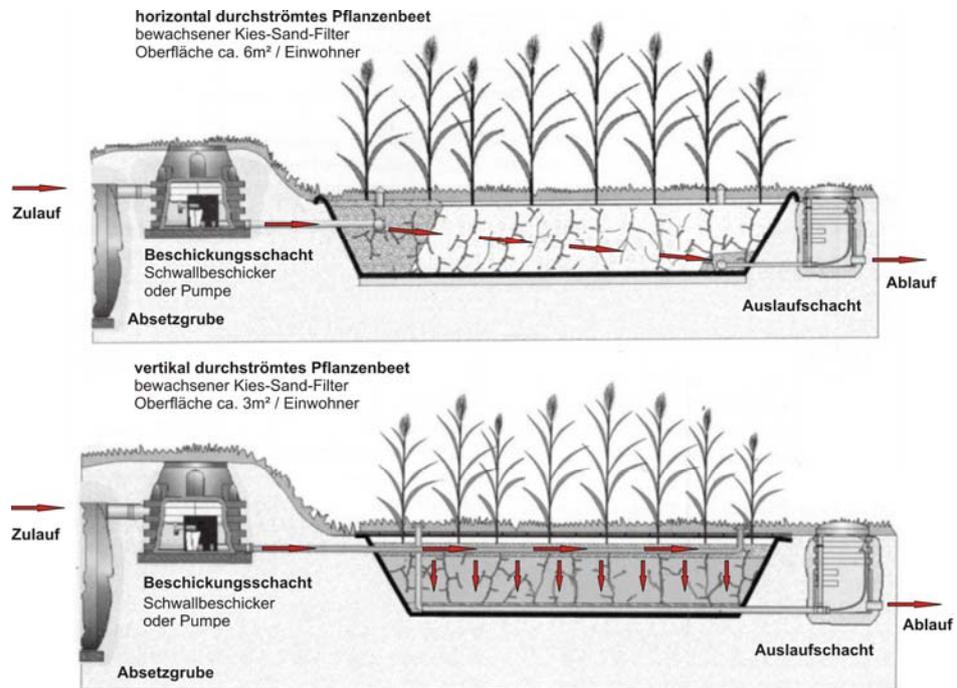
Aufbau und Funktion vertikal und horizontal durchströmter Pflanzenkläranlagen (Gerwal 2003)
